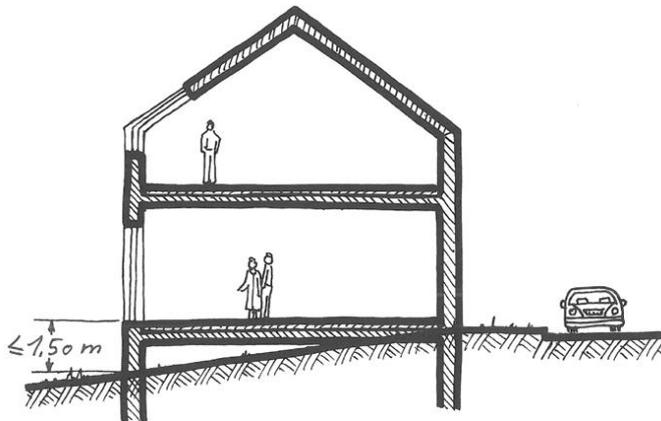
Différence de hauteur entre le terrain naturel et le rez-de-chaussée ou le rez-de-jardin
